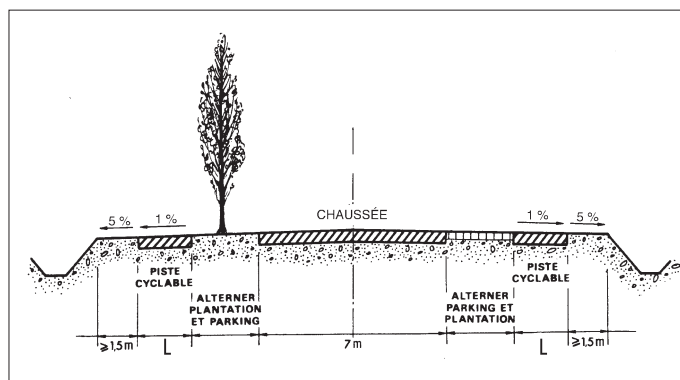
Coupe en travers-type d'une piste cyclable unidirectionnelle aménagée de part et d'autre d'une route à fort trafic
